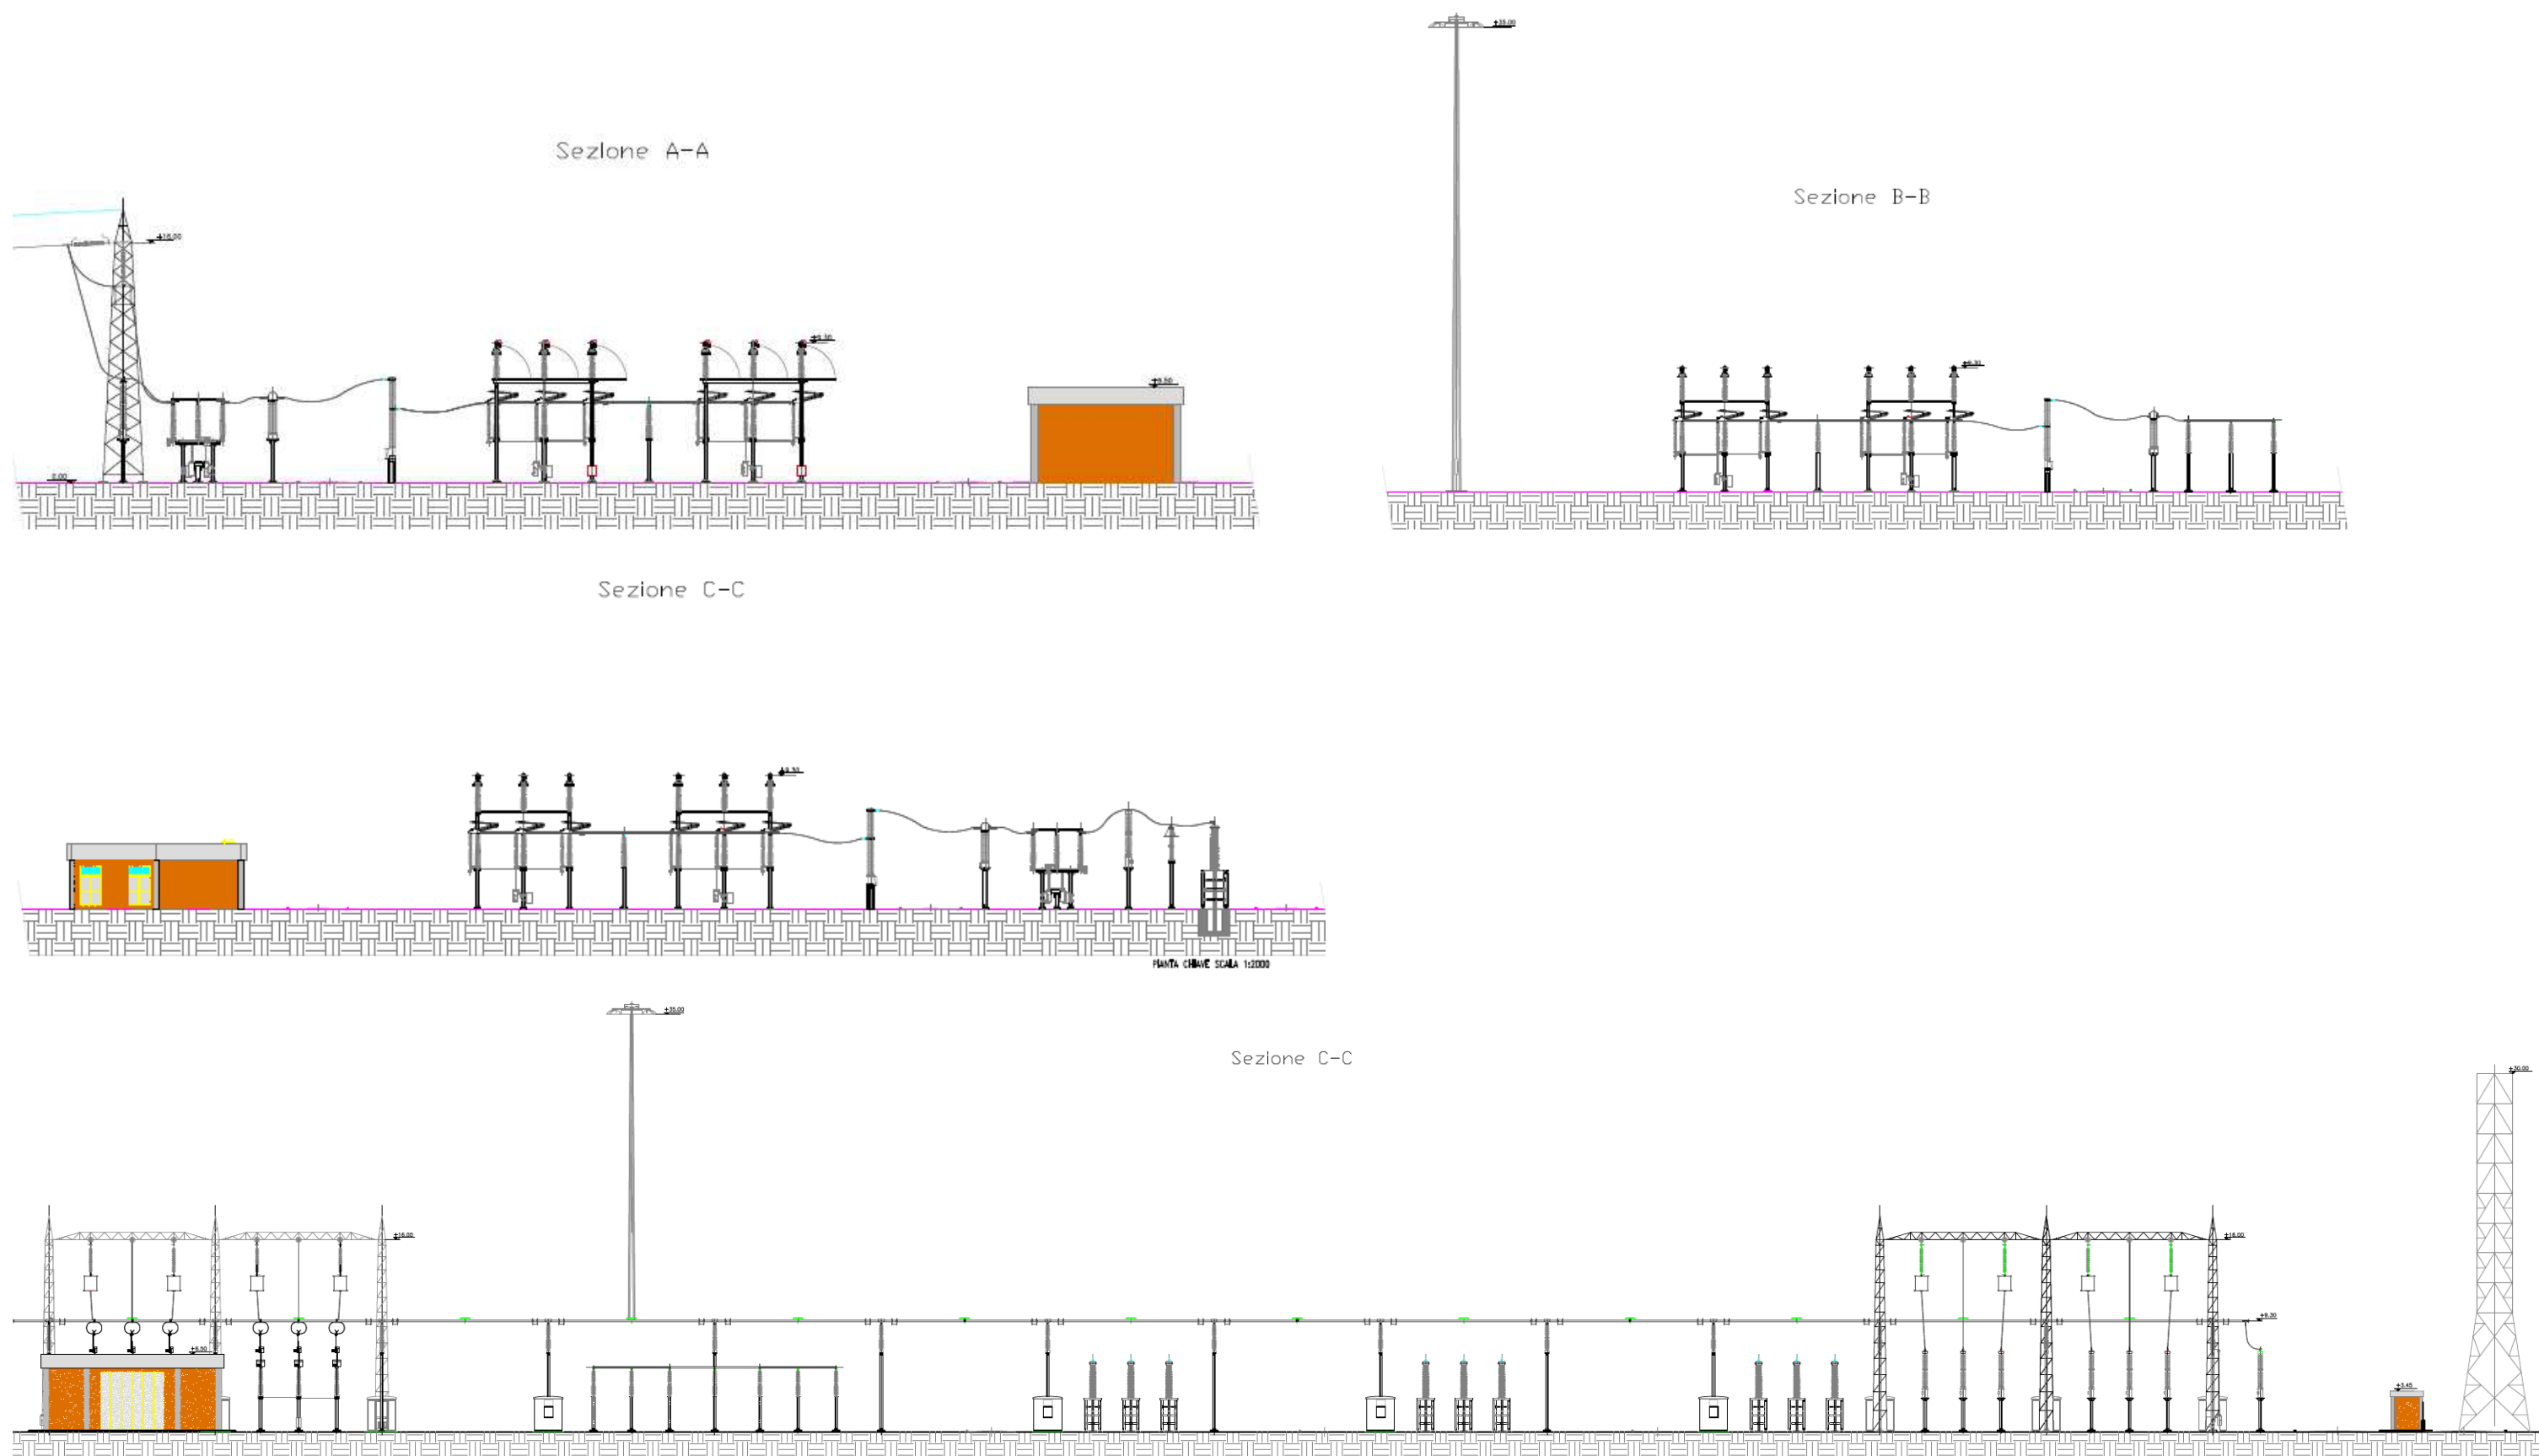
Rifacimento SE Malcontenta - Sezioni elettromeccaniche
